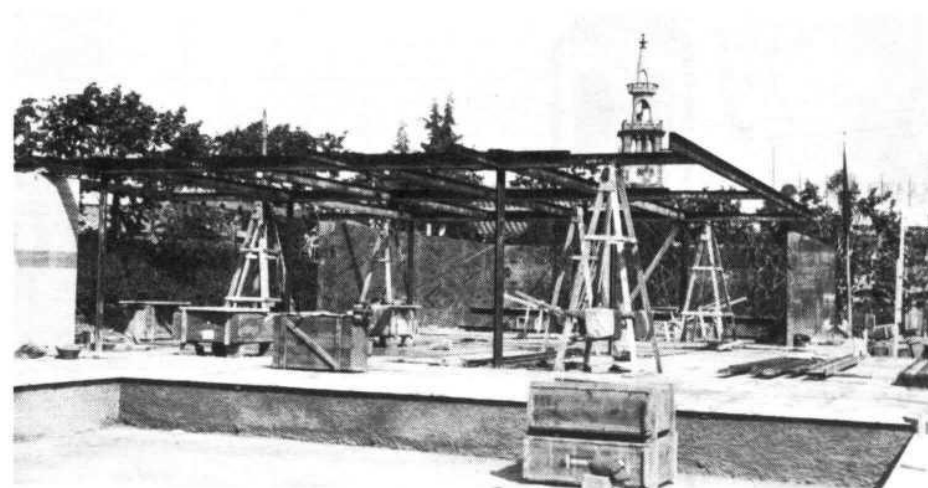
Pabellón de Barcelona: fotografía durante la construcción
